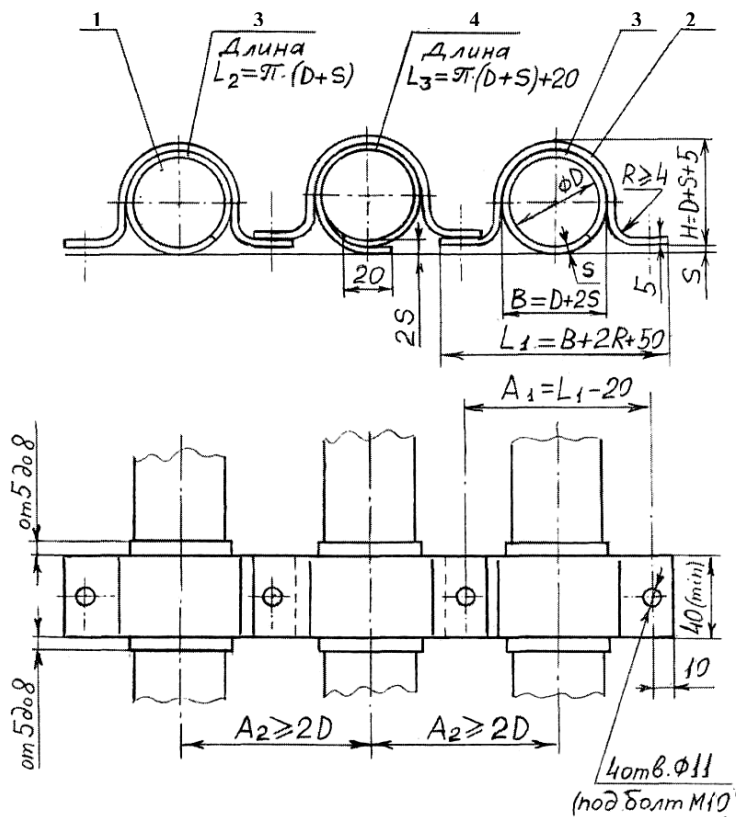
Крепление трёх кабелей к металлоконструкции.
